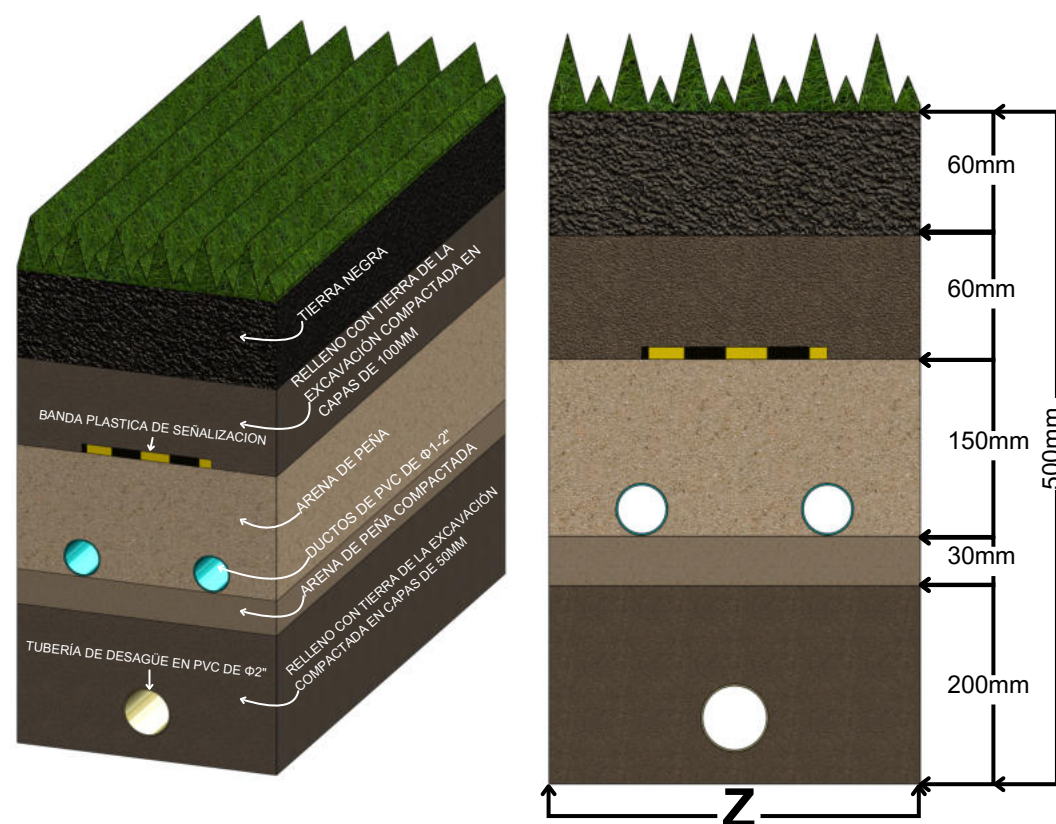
Capas de relleno recomendadas para zanjas en zonas verdes sobre ductos de baja tensión de alumbrado público.
